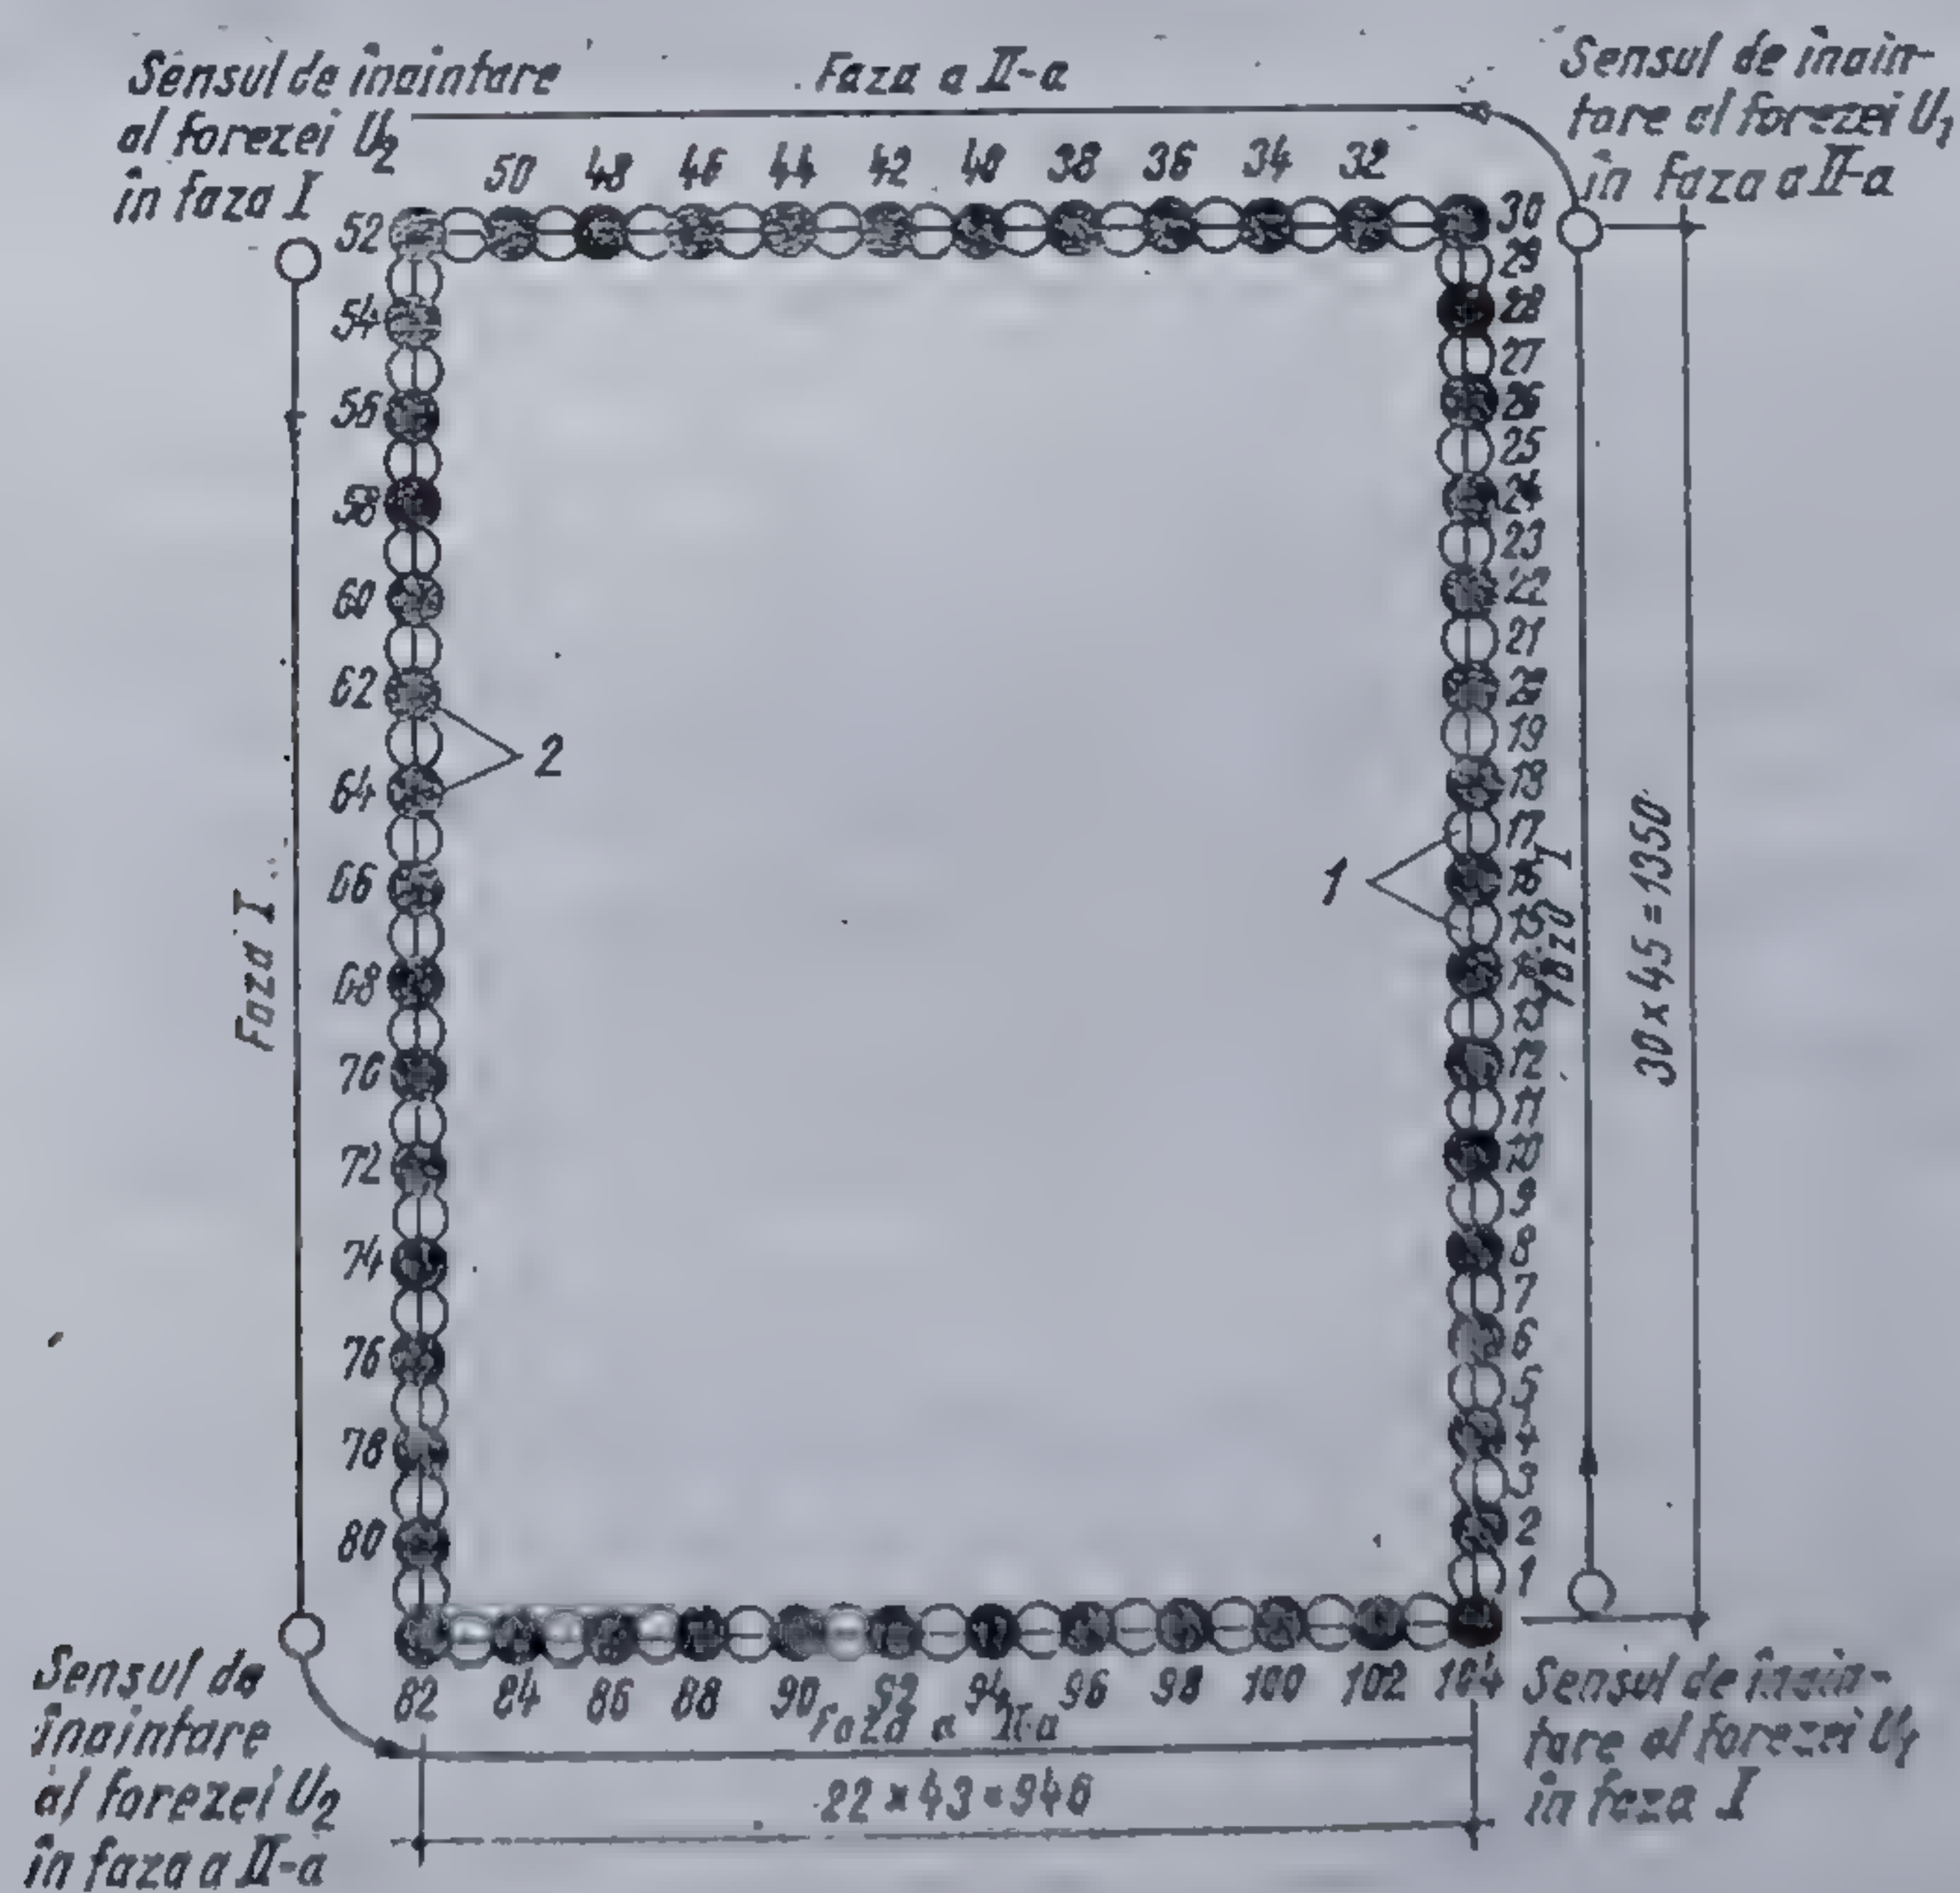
Planul de execuție a piloților secanți în jurul unei incinte de fundare :
